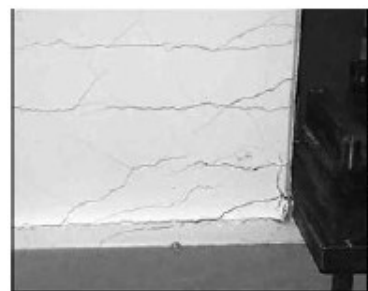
Patrón de falla para muros con refuerzo de malla de barras laminadas en caliente
